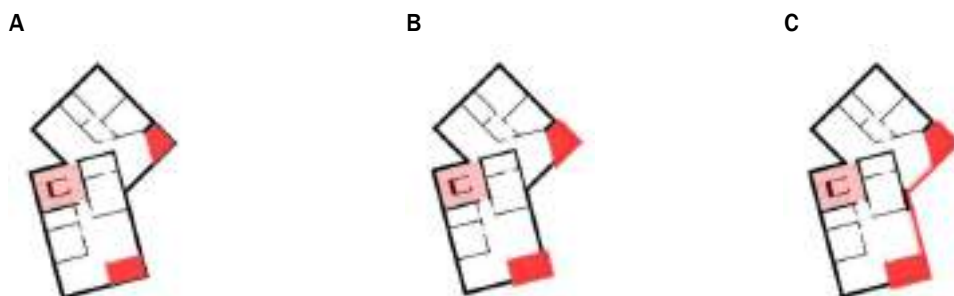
Balkonsituationen mit Grundrissvarianten
